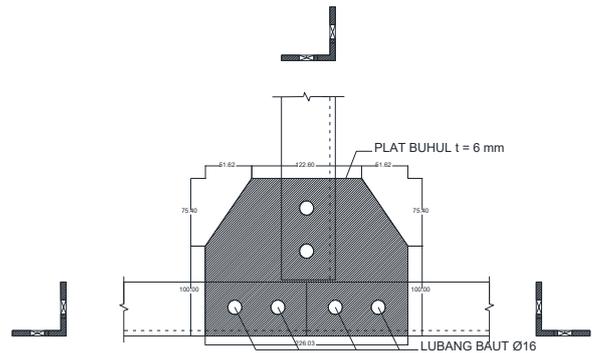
Tampak Bawah Dan Denah Detail Sambungan
